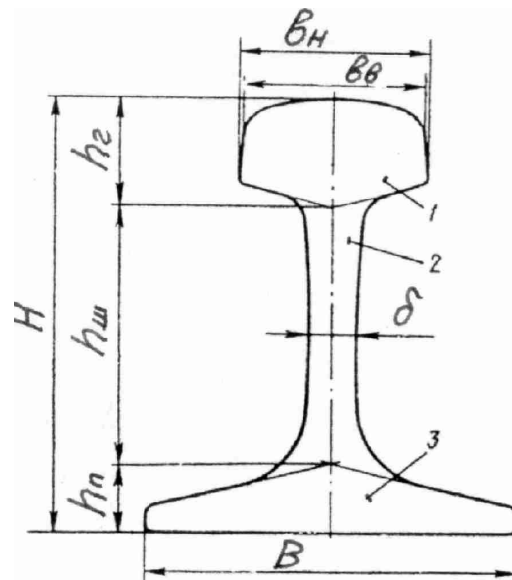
Будова та основні параметри залізничної рейки: 1 – головка рейки; 2 – шийка; 3 – підошва; H – висота рейки; B – ширина підошви; b_B , b_H – ширина головки зверху та знизу; h_G , $h_{Ш}$, h_P – висота головки, шийки та підошви; δ – товщина шийки
